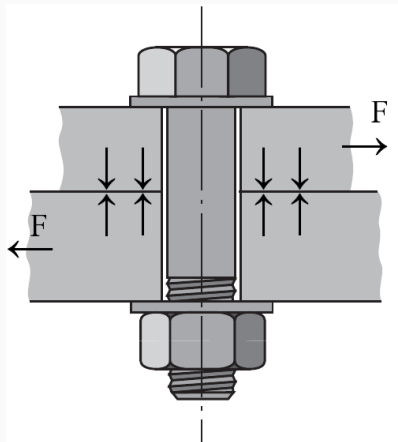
Ligação com pré-esforço e carregamento no plano da ligação [1].
